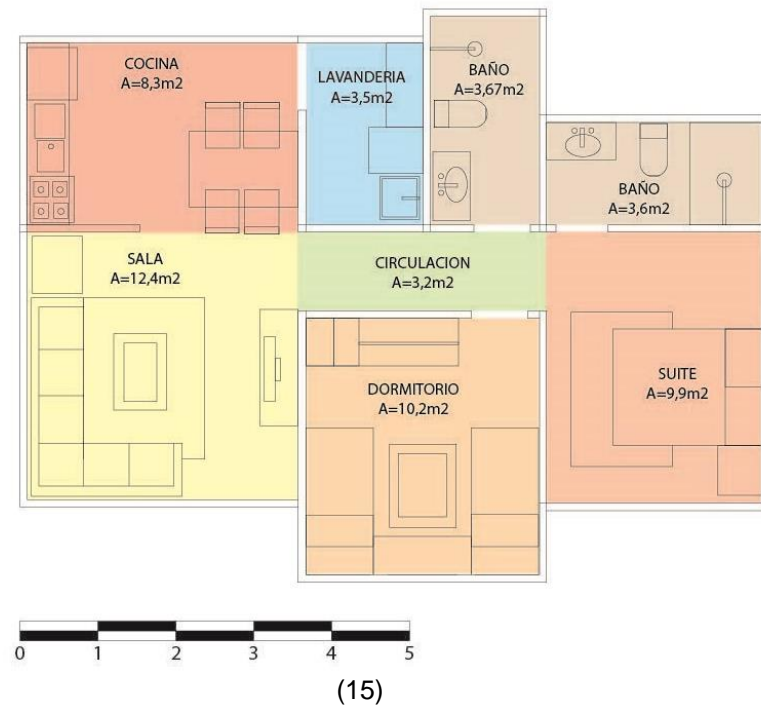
Fuente:(Plano de casa.2018) Elaboración: Autor
